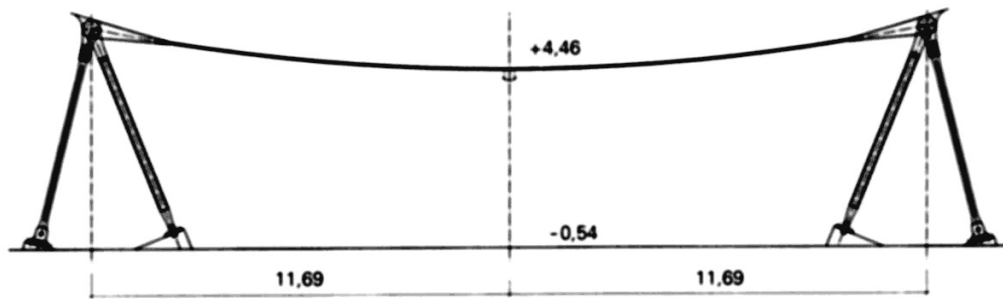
Hängedach mit Dachflächenentwässerung über Quergefälle zu Fallrohr am Längsrand
